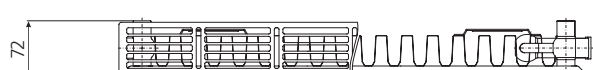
Радиатор «PRADO Universal» в разрезе, с двумя нижними и четырьмя боковыми присоединительными отверстиями
